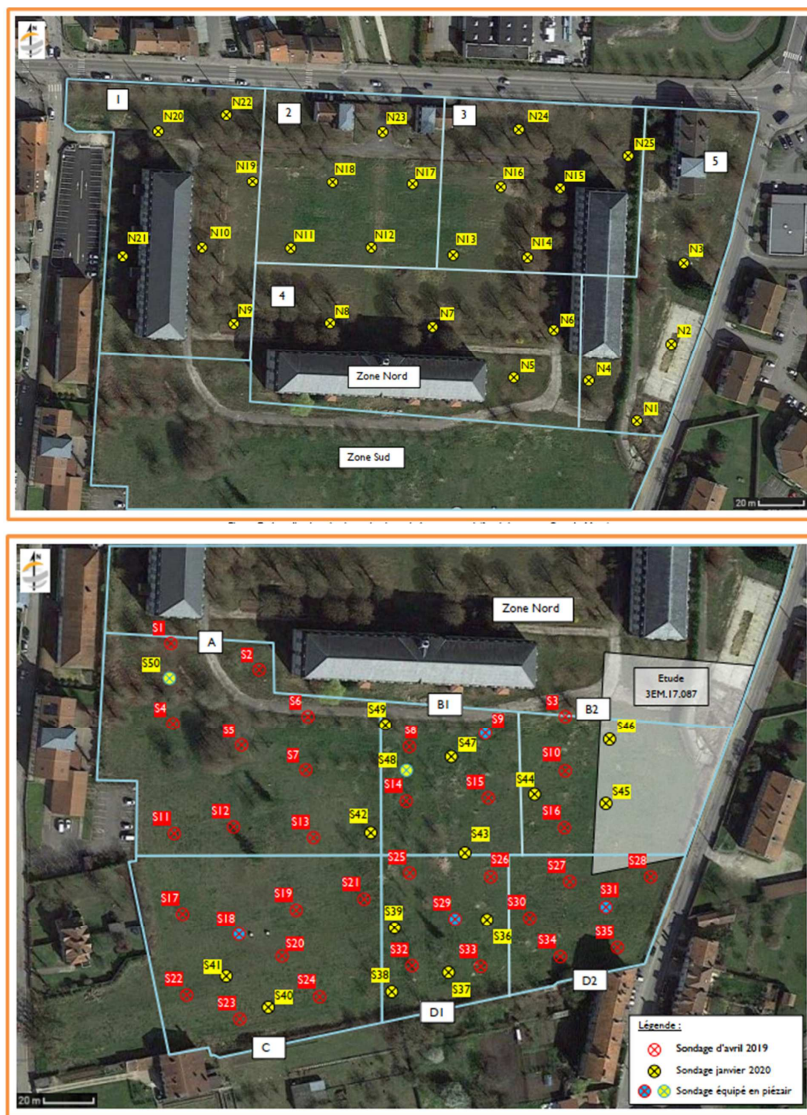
Plan de localisation des sondages au droit de la zone Nord et de la zone Sud (Source FONDASOL)
